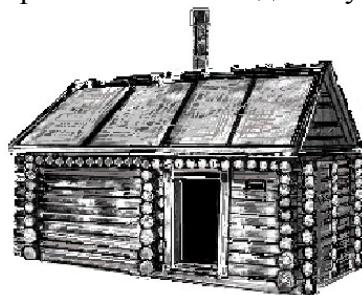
Наглядный вид охотничьей избы [2]
